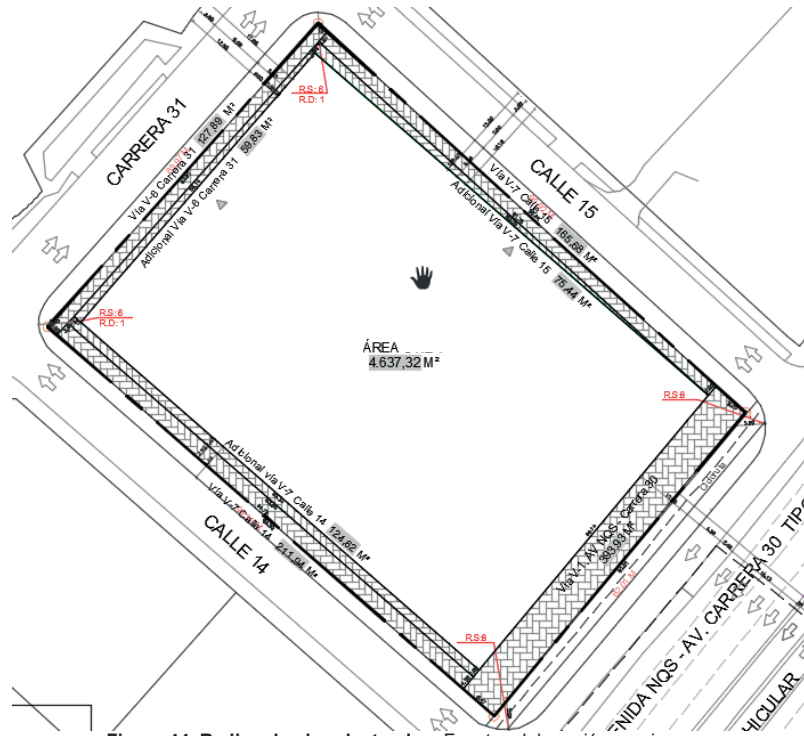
Radios de giro planteados. Fuente: elaboración propia
